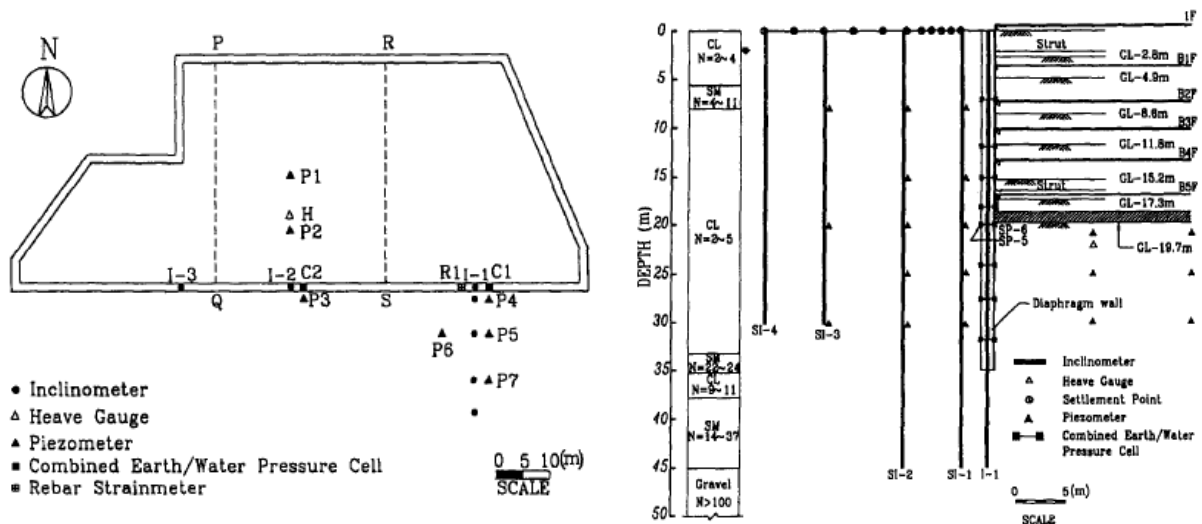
Vue en plan et coupe transversale du TNEC (Ou et al. 1998)
